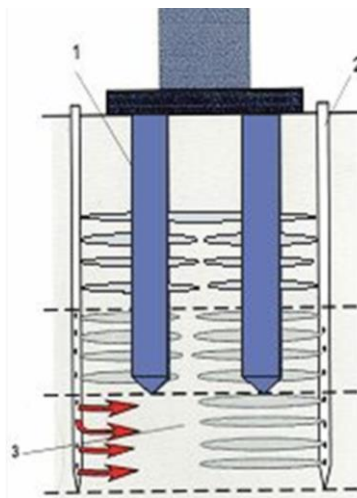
Схема укріплення пальового фундаменту: 1 – паля, 2 – ін'єктор, 3 – геокомпозитне утворення
